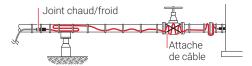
Achèvement de l'installation du câble chauffant à isolation minérale (IM)
